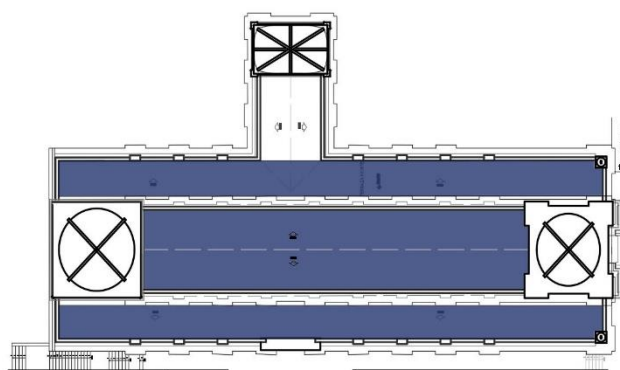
Incorporación de una cubierta provisional sobrepuesta en terrazas
